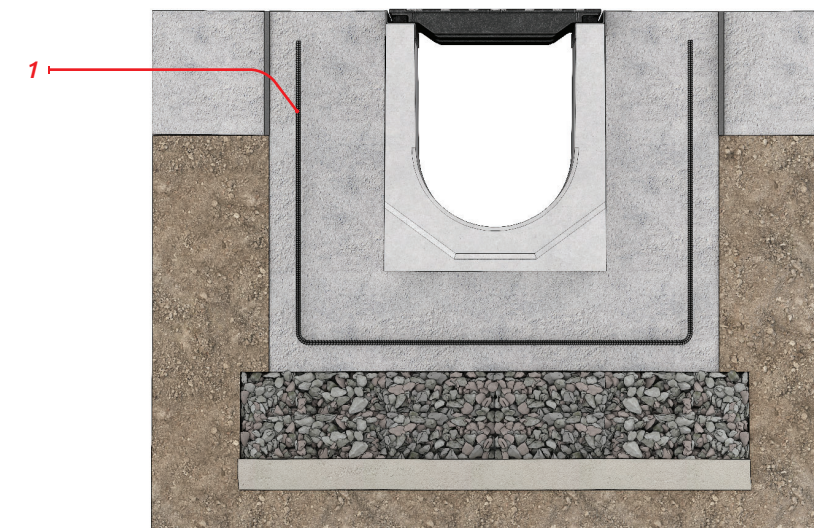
Пример армирования обоймы водоотводного лотка для вертолетной площадки.
